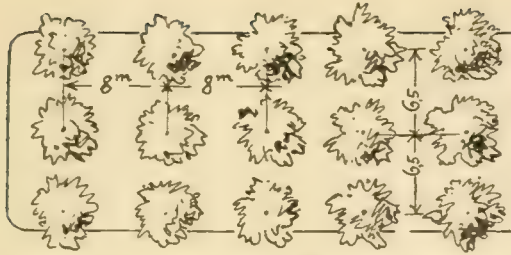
Grundriss bei dreifacher Reihenbildung.
